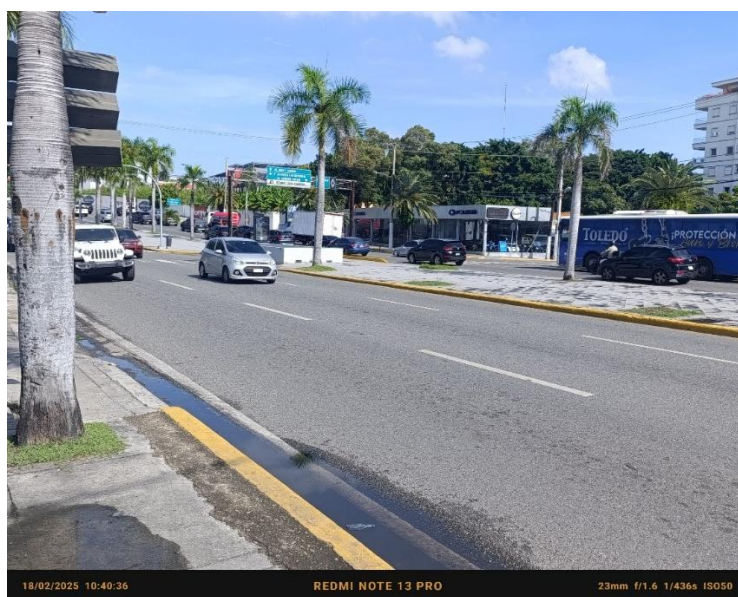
Colindancia Norte, Vista de la Avenida Rómulo Betancourt
